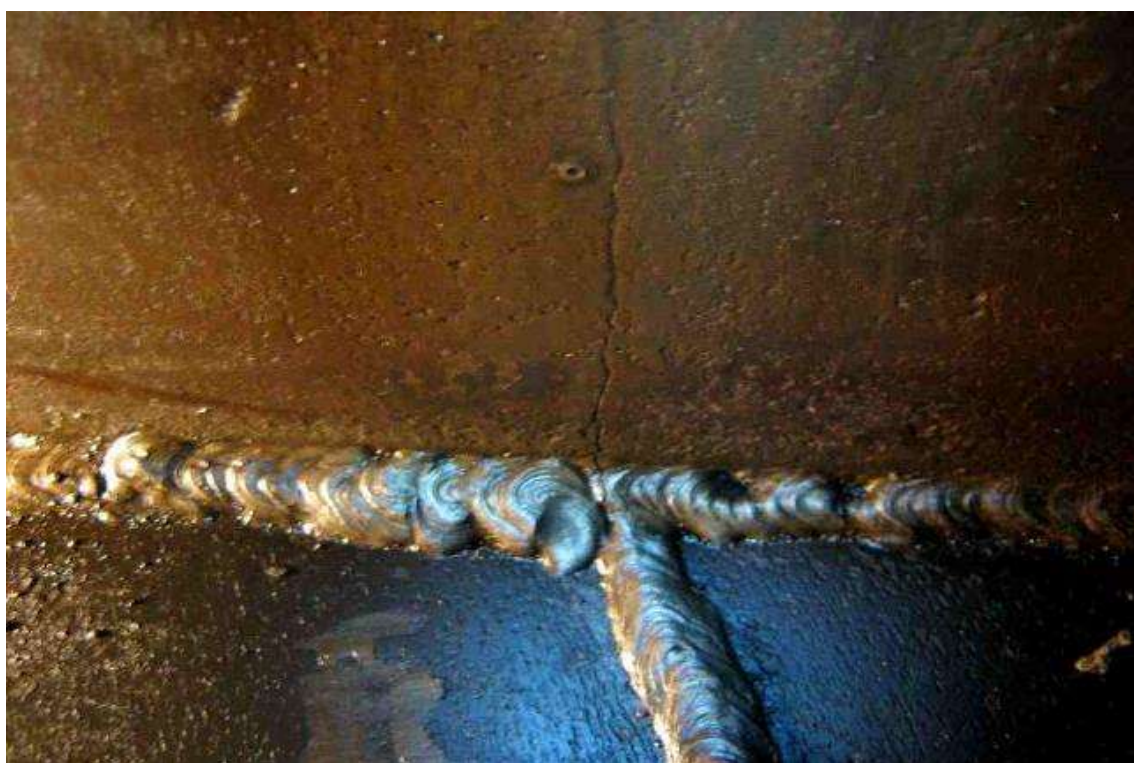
Трещина №2 в зоне уторного соединения резервуара, вид с внутренней стороны резервуара
